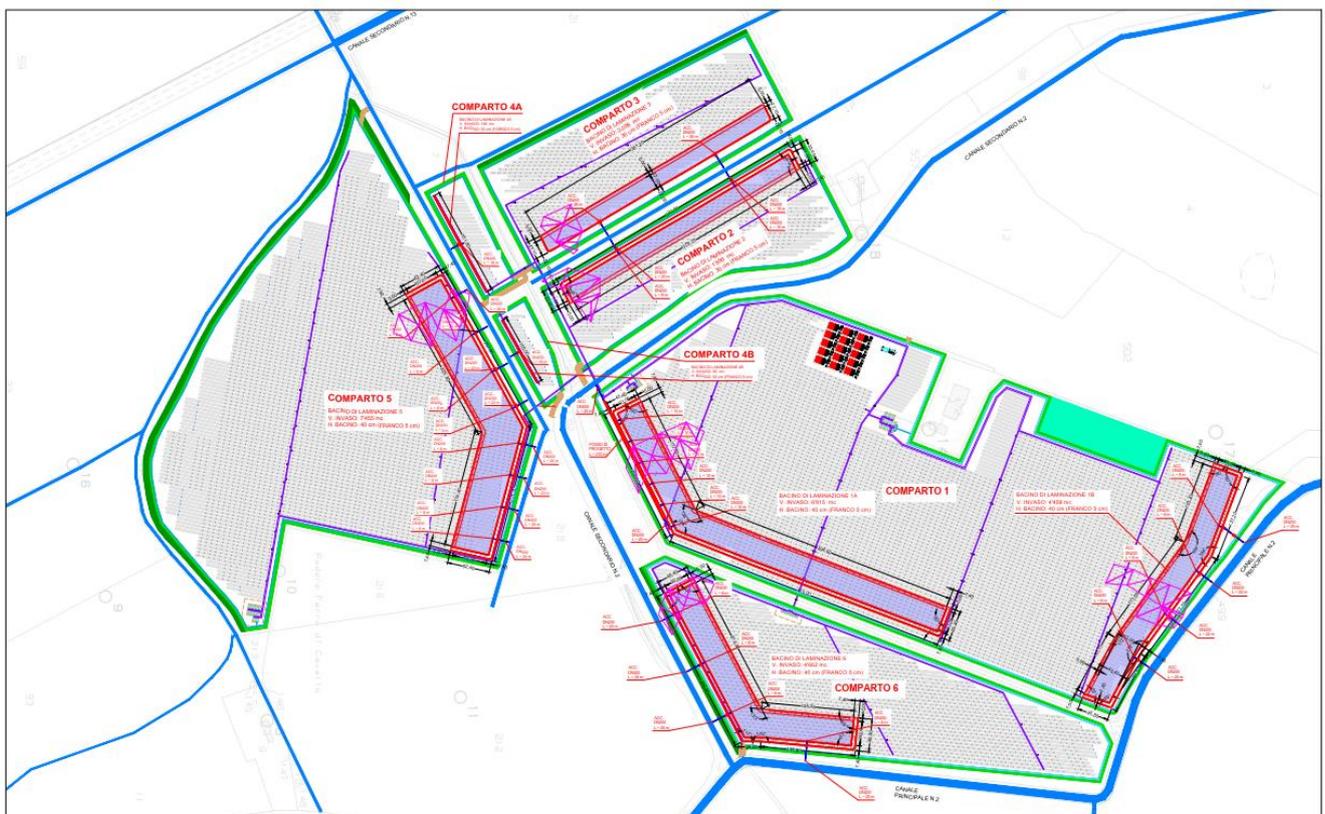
ESTRATTO PLANIMETRICO BACINI DI PROGETTO
